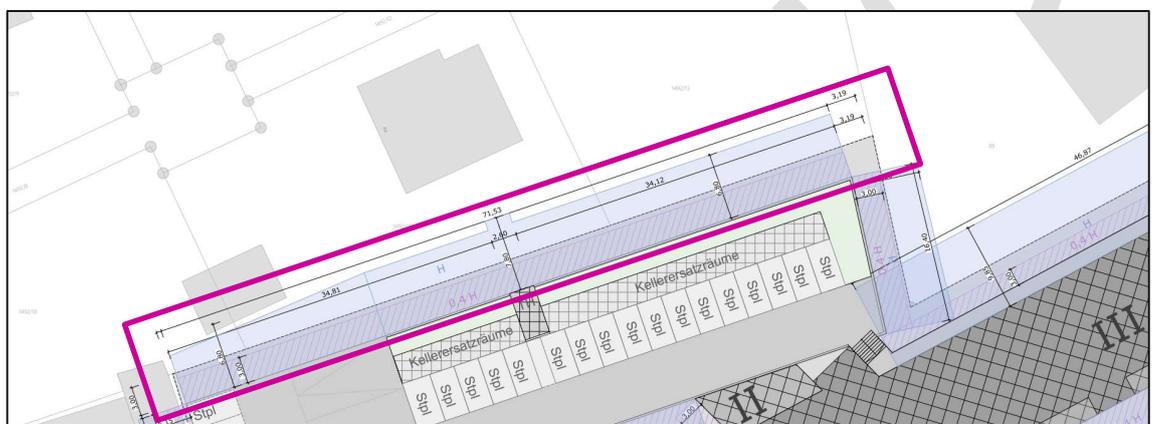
Auszug VEP Lageplan mit Abstandsflächen nach BayBO (Plan NR. 02.2); BERZ.Architekten i. d. F. v. 28.01.2020, o. M.
